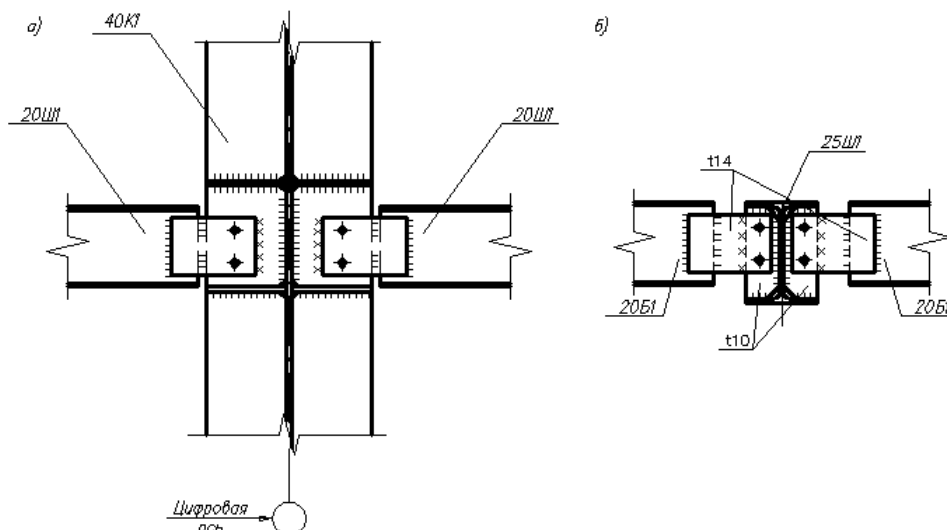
Узлы сопряжения: а) второстепенных балок с колонной; б) второстепенных балок с главной балкой
